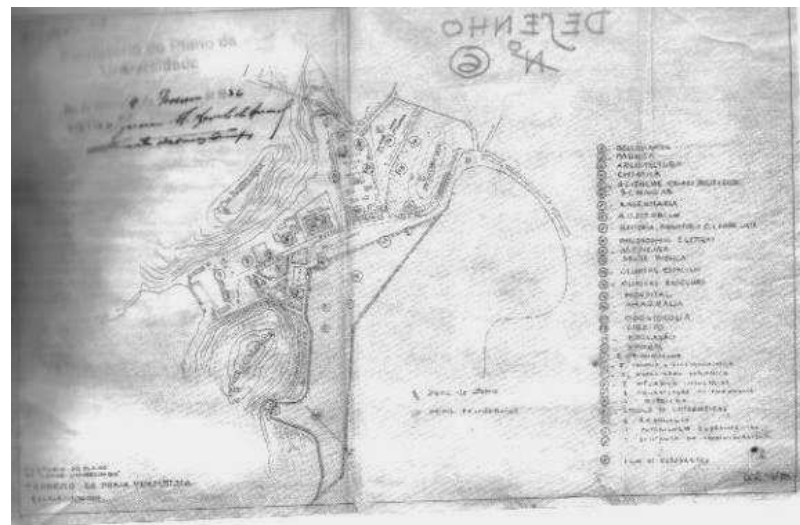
Planta do Projeto do Prof. Saboya Ribeiro.
